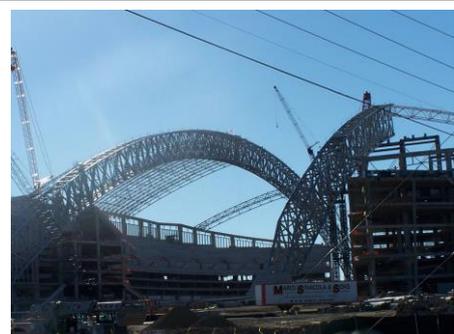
la poutre à membrures non parallèle utilisée dans le projet
